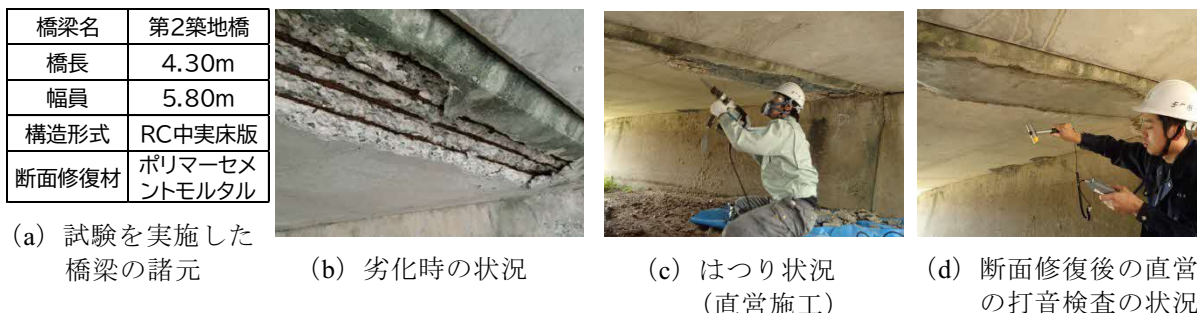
非破壊試験を実施した直営施工による橋梁の諸元および補修施工の実施状況
